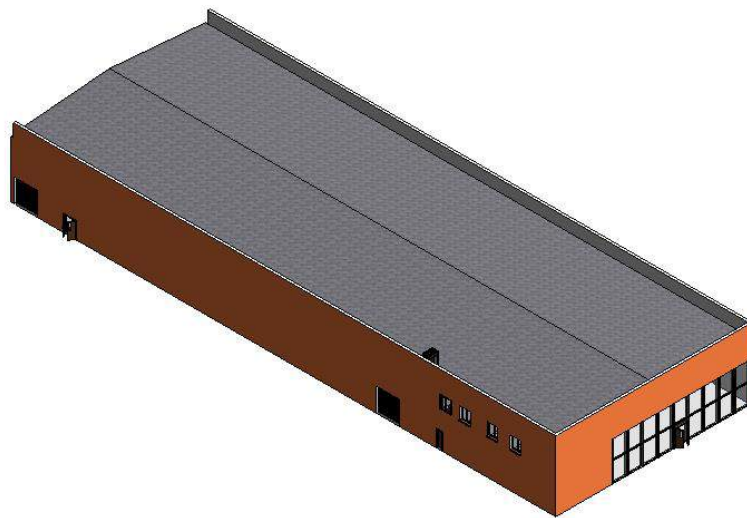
Vista 3D nave para fabricación y venta de muebles.
